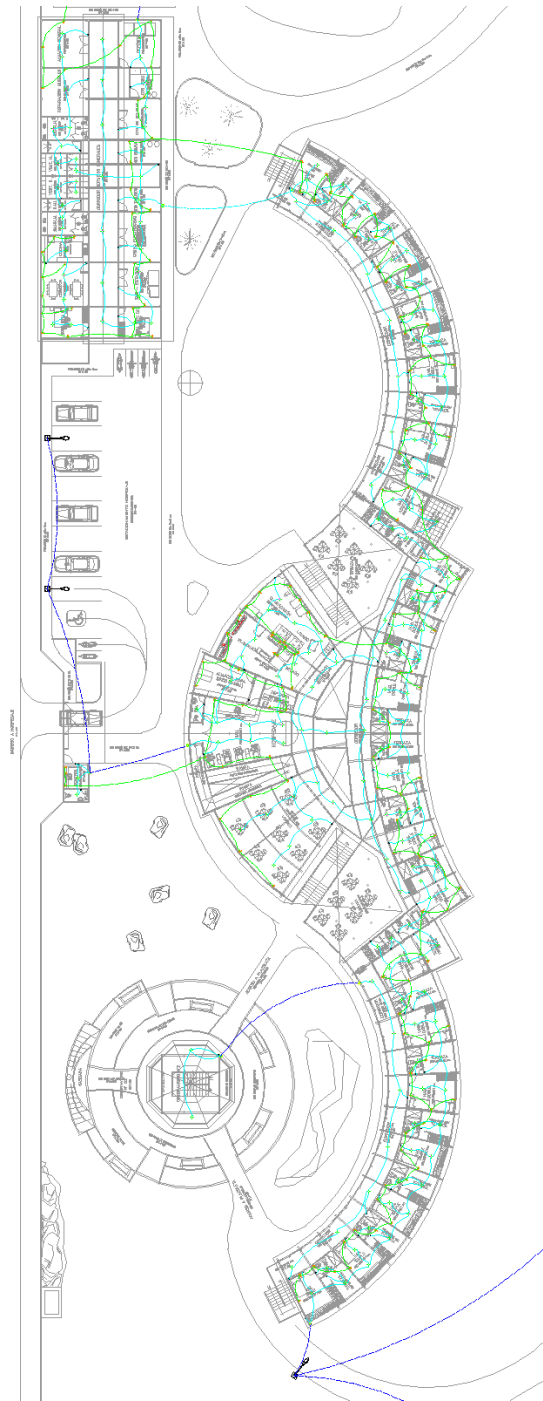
Plano instalaciones eléctricas de bloque hospedaje
